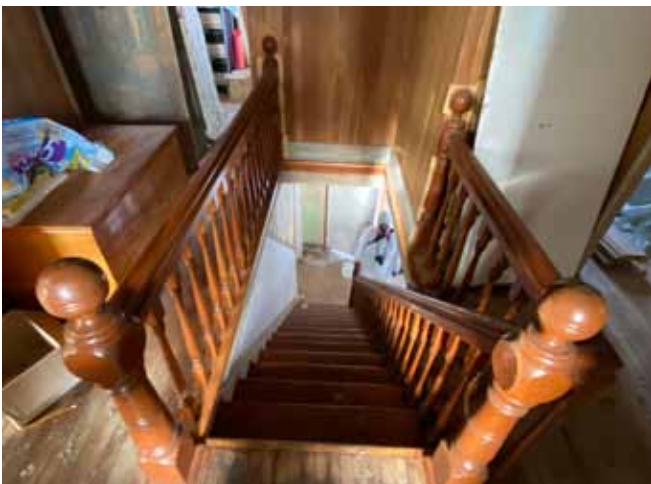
À l'étage, la trémie de l'escalier est protégée par un garde-corps sur deux côtés constitués d'une main courante supportée par des balustres tournés, le tout en bois verni.
